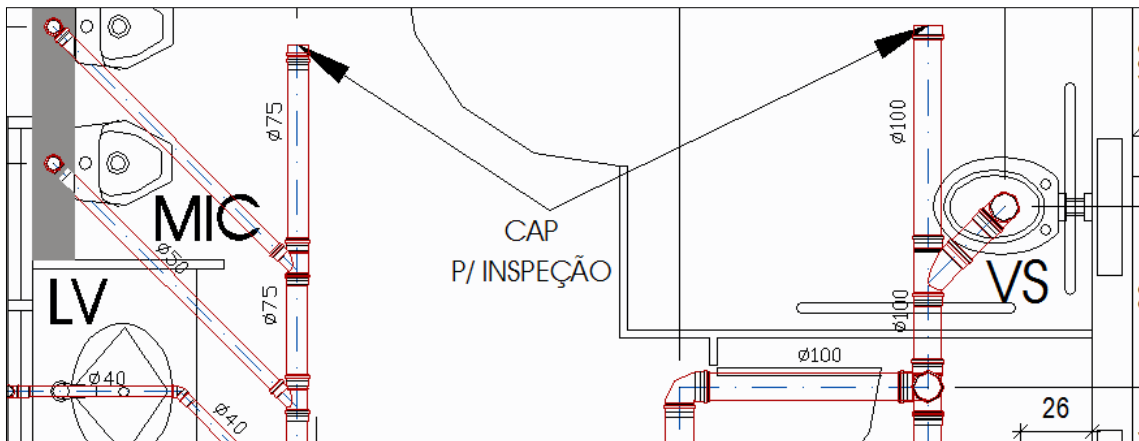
Desenho Técnico detalhe do cap; Fonte: Rodovalho, R. Ana Cristina
